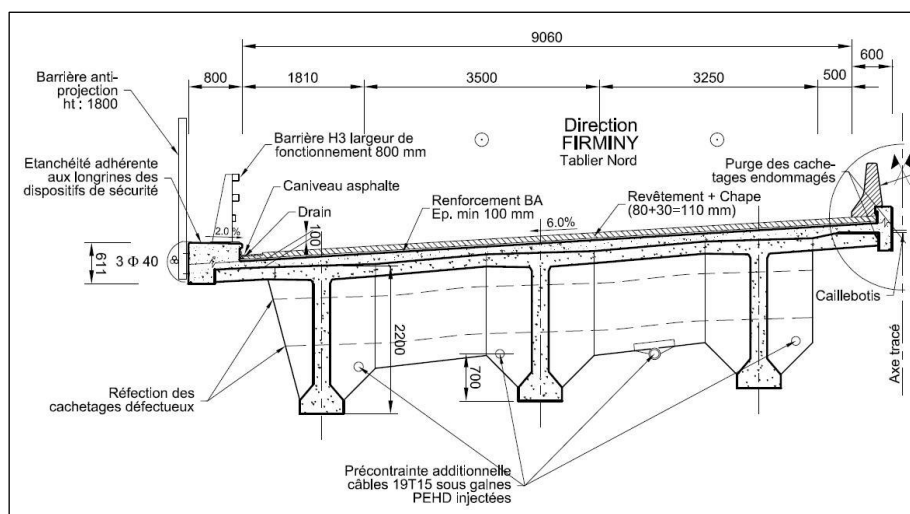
Coupe transversale au niveau de la première entretoise intermédiaire
